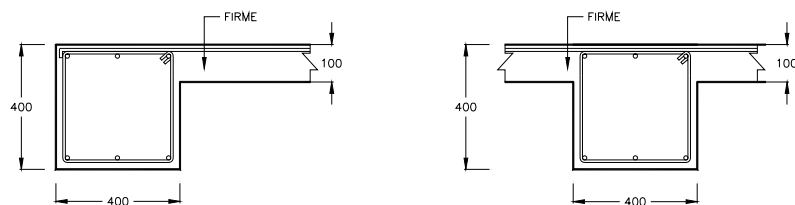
Detalle de cimentación (acotaciones en mm)
